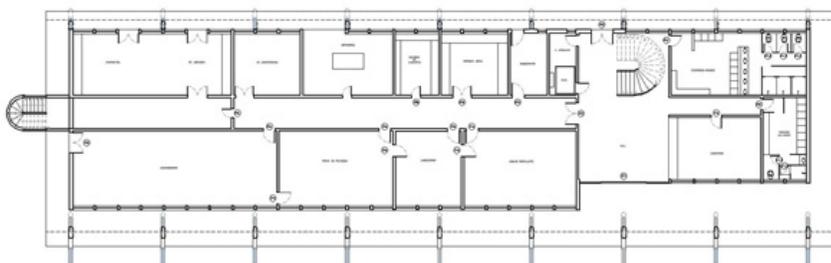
Laboratório da Febre Amarela: redesenho da planta baixa do 1º pavimento, 1954.
